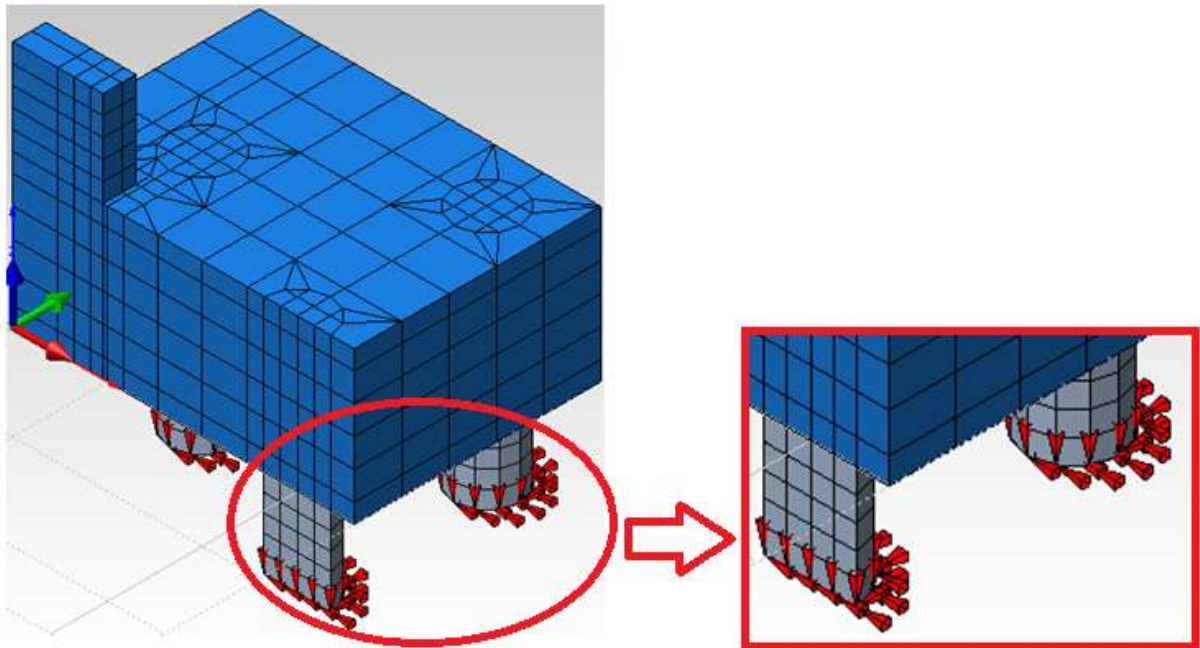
Bloco com apoio indeformável. Carga no pilar
